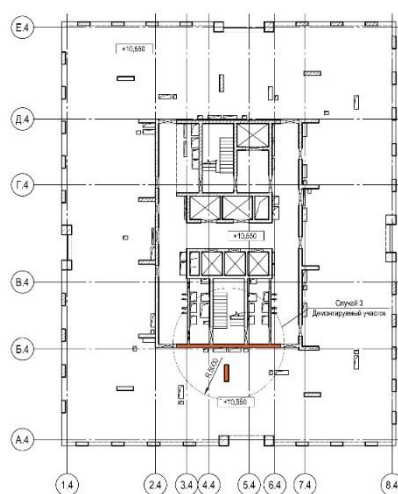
Корпус К-4. Схема аварийного случая 3
